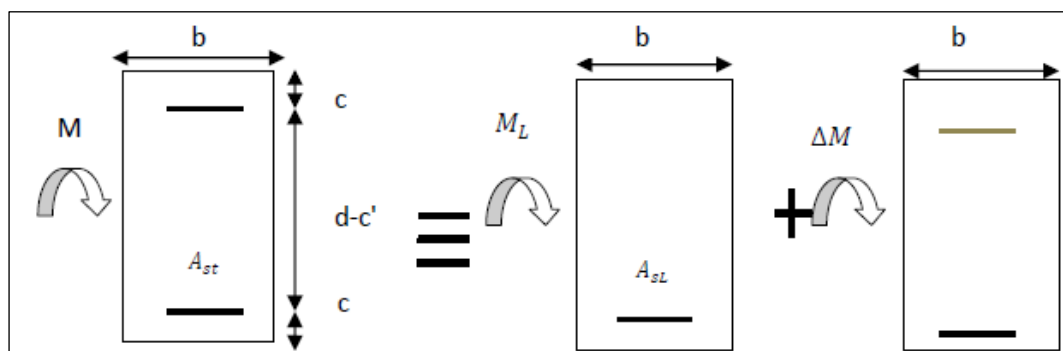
Schéma de Ferrailage des poutres doublement armée
